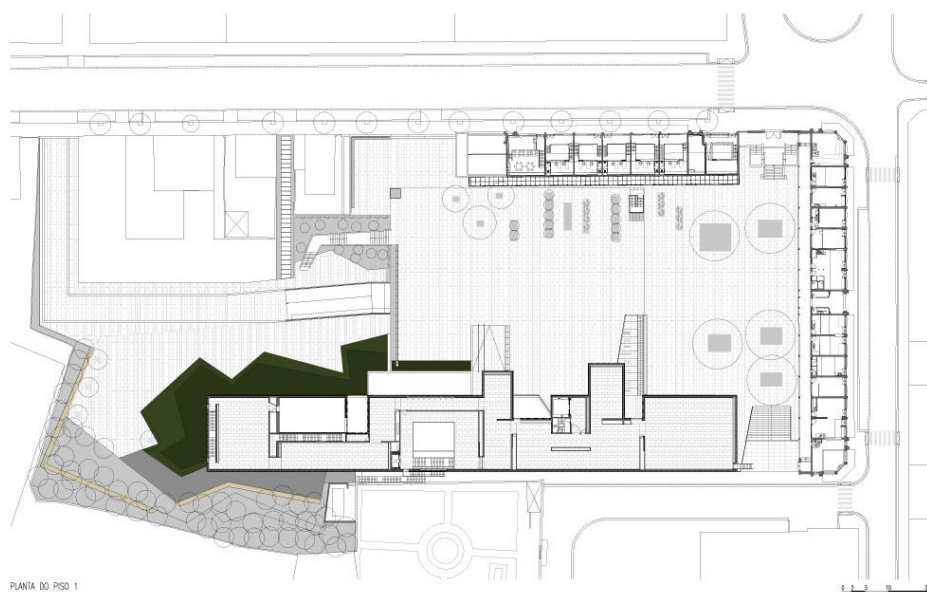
Plano arquitectónico del Centro Internacional para las Artes Jose de Guimarães. Recuperado de ArchDaily.
